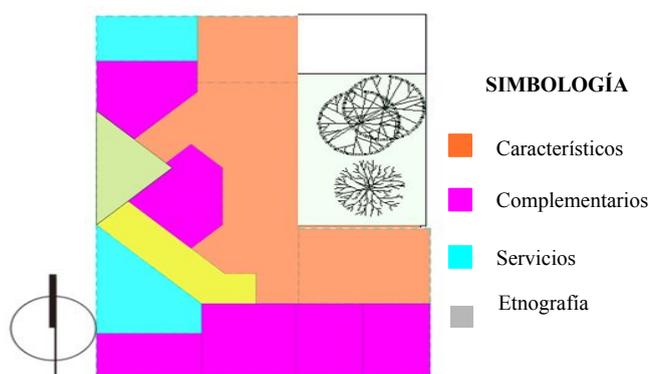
Planta de propuesta 1 de diseño volumétrico.
